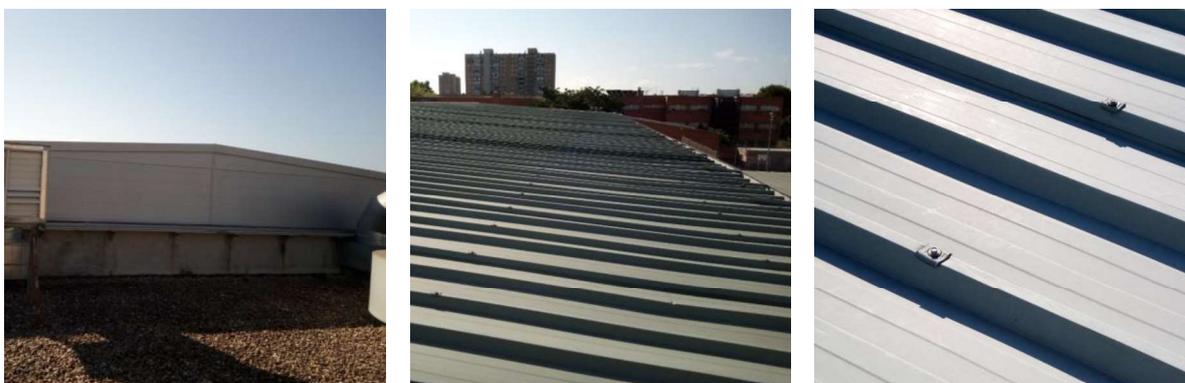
Cubierta del pabellón (bloque F). Fuente: Propia.
